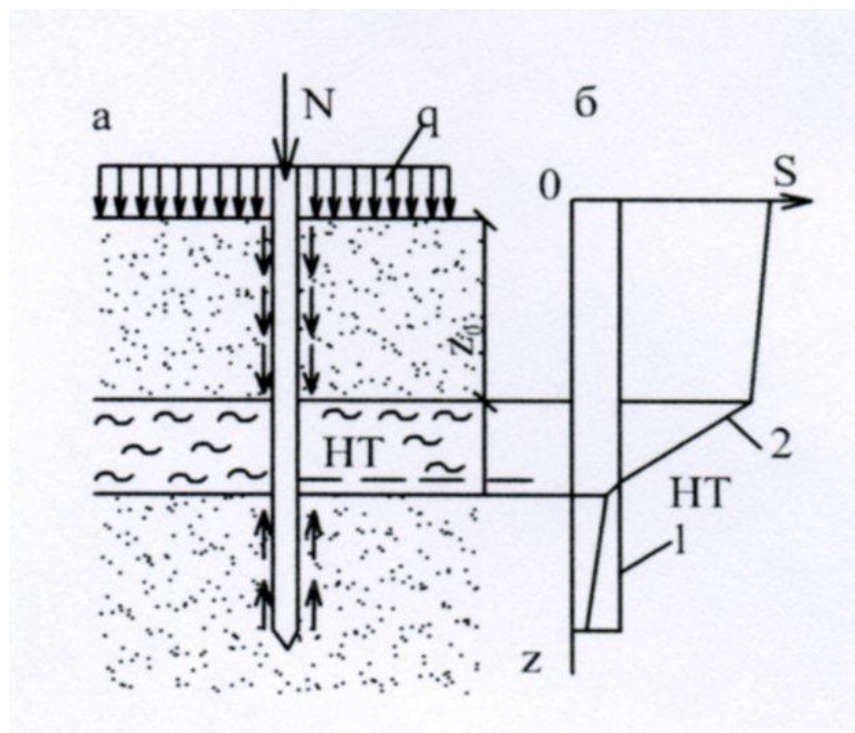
Влияние сил отрицательного трения (Проектирование фундаментов...2006).
